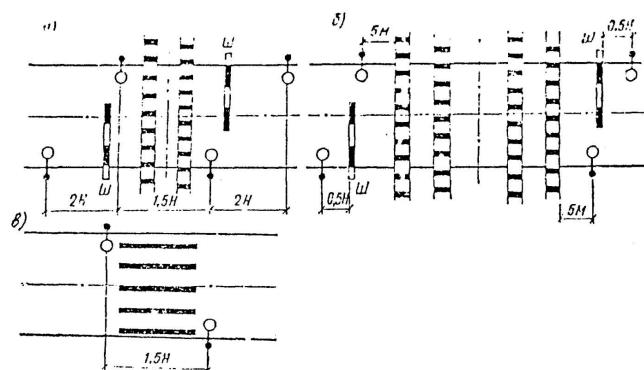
Схемы размещения светильников а, б - на железнодорожных переездах; в - на пешеходном переходе; ш - автоматический шлагбаум
